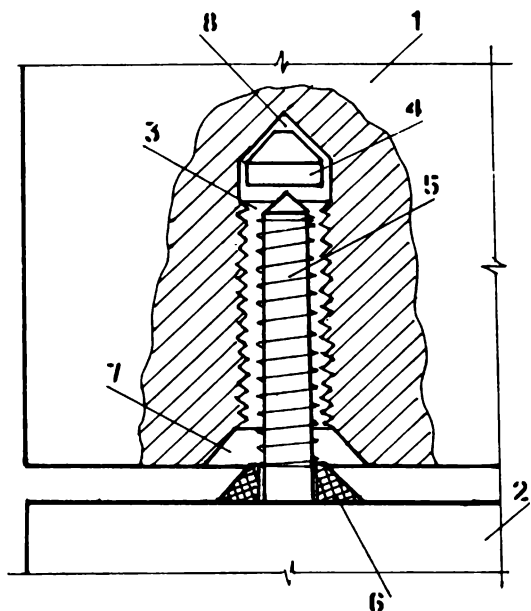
Унифицированный клеевой монтажный стык для железобетонных конструкций
